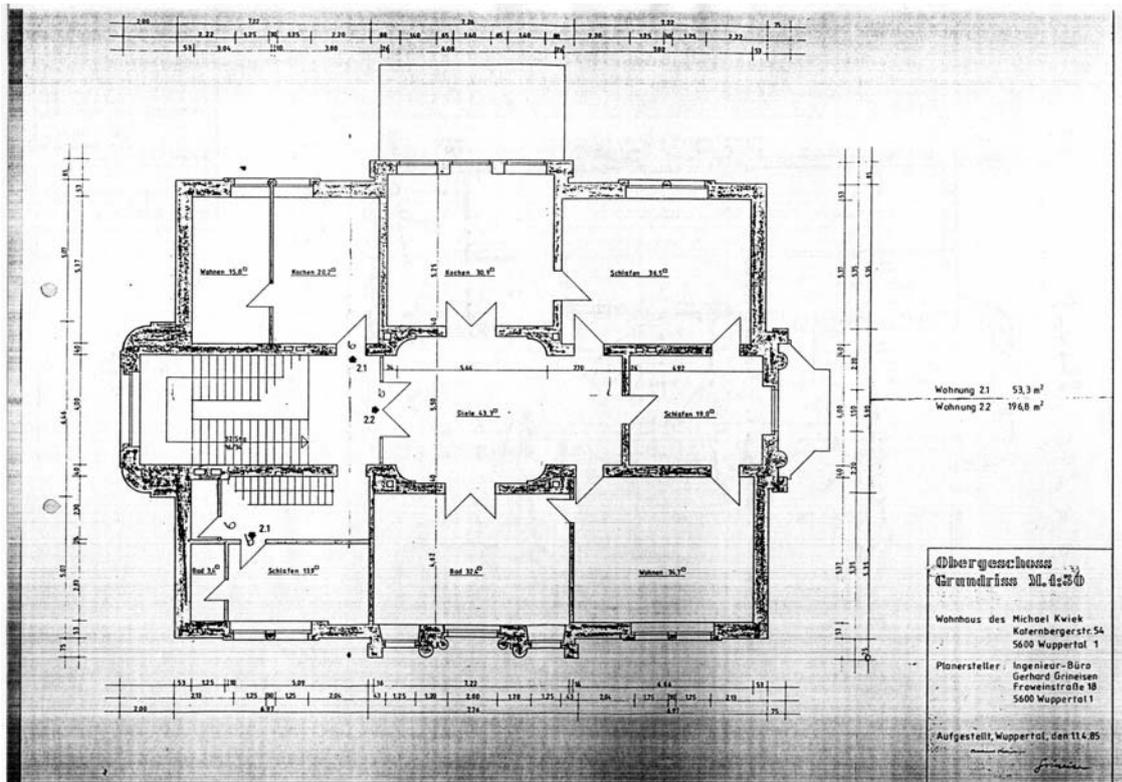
Villa Otto Baum, Grundriss Obergeschoss, angefertigt vom Ingenieur-Büro Grineisen, Wuppertal, 1985
